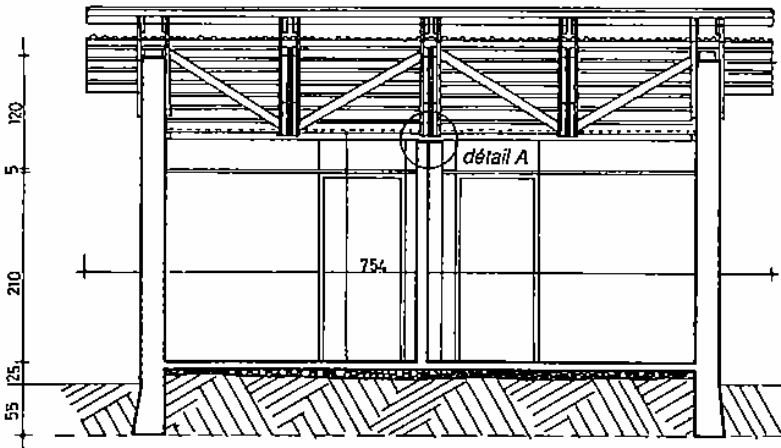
Coupe de mur pignon à mur pignon : noter le contreventement longitudinal par pièces obliques assemblées par cloutage entre les entrails et les arbalétriers des fermes.
